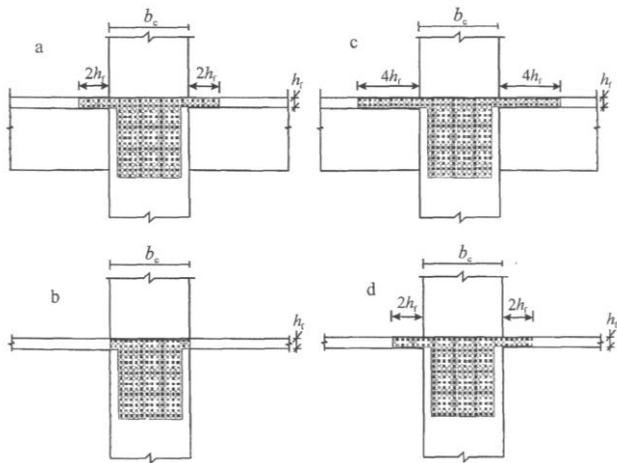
Ефективна ширина полиці b_{eff} для балок, утворюючих рами з колонами
